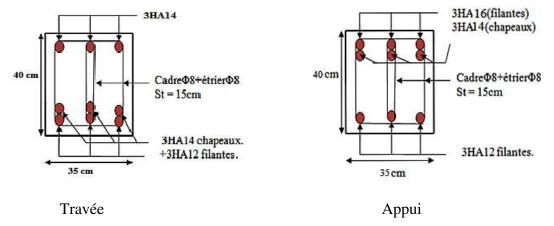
Schéma de ferraillage des poutres principales des Etages 8-9.
